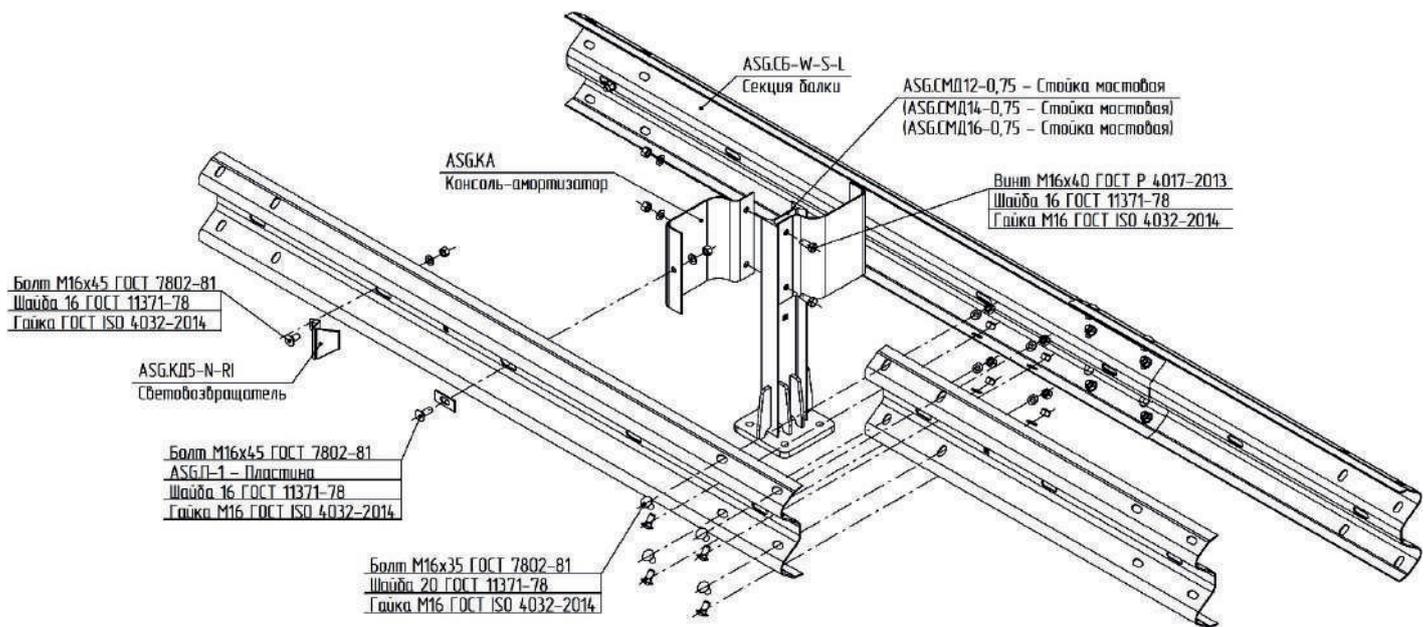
Схема сборки конструкции №5, №6
